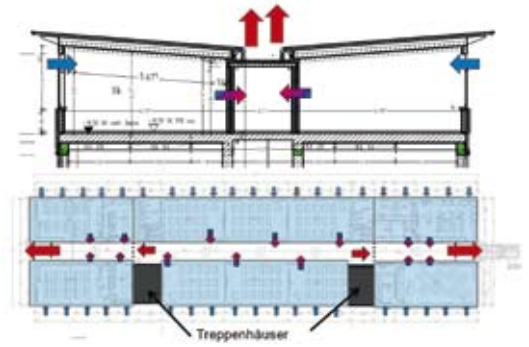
Luftwege im Dachgeschoss (Oststadtschule)
